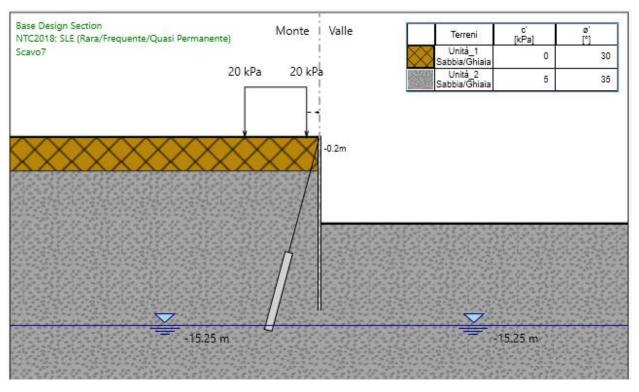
Fase 10: scavo fino alla quota -7 m da piano stradale
